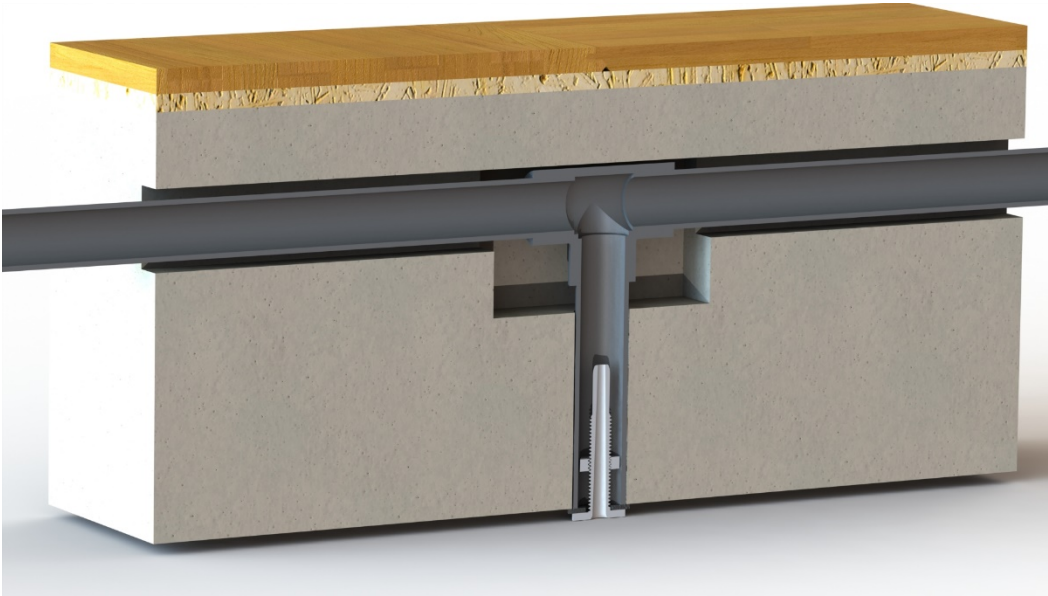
, Монтаж аспирационной трубы внутри бетонных конструкций здания
